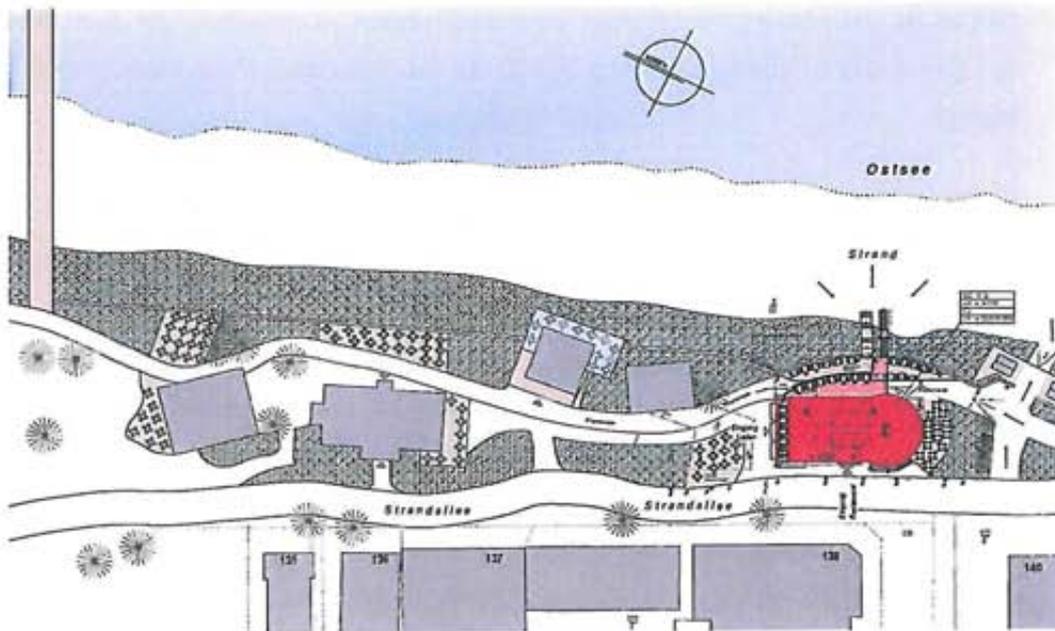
Lageplan Neubau, Architektur - und Planungsbüro Dipl.-Ing. Roger Krancher
